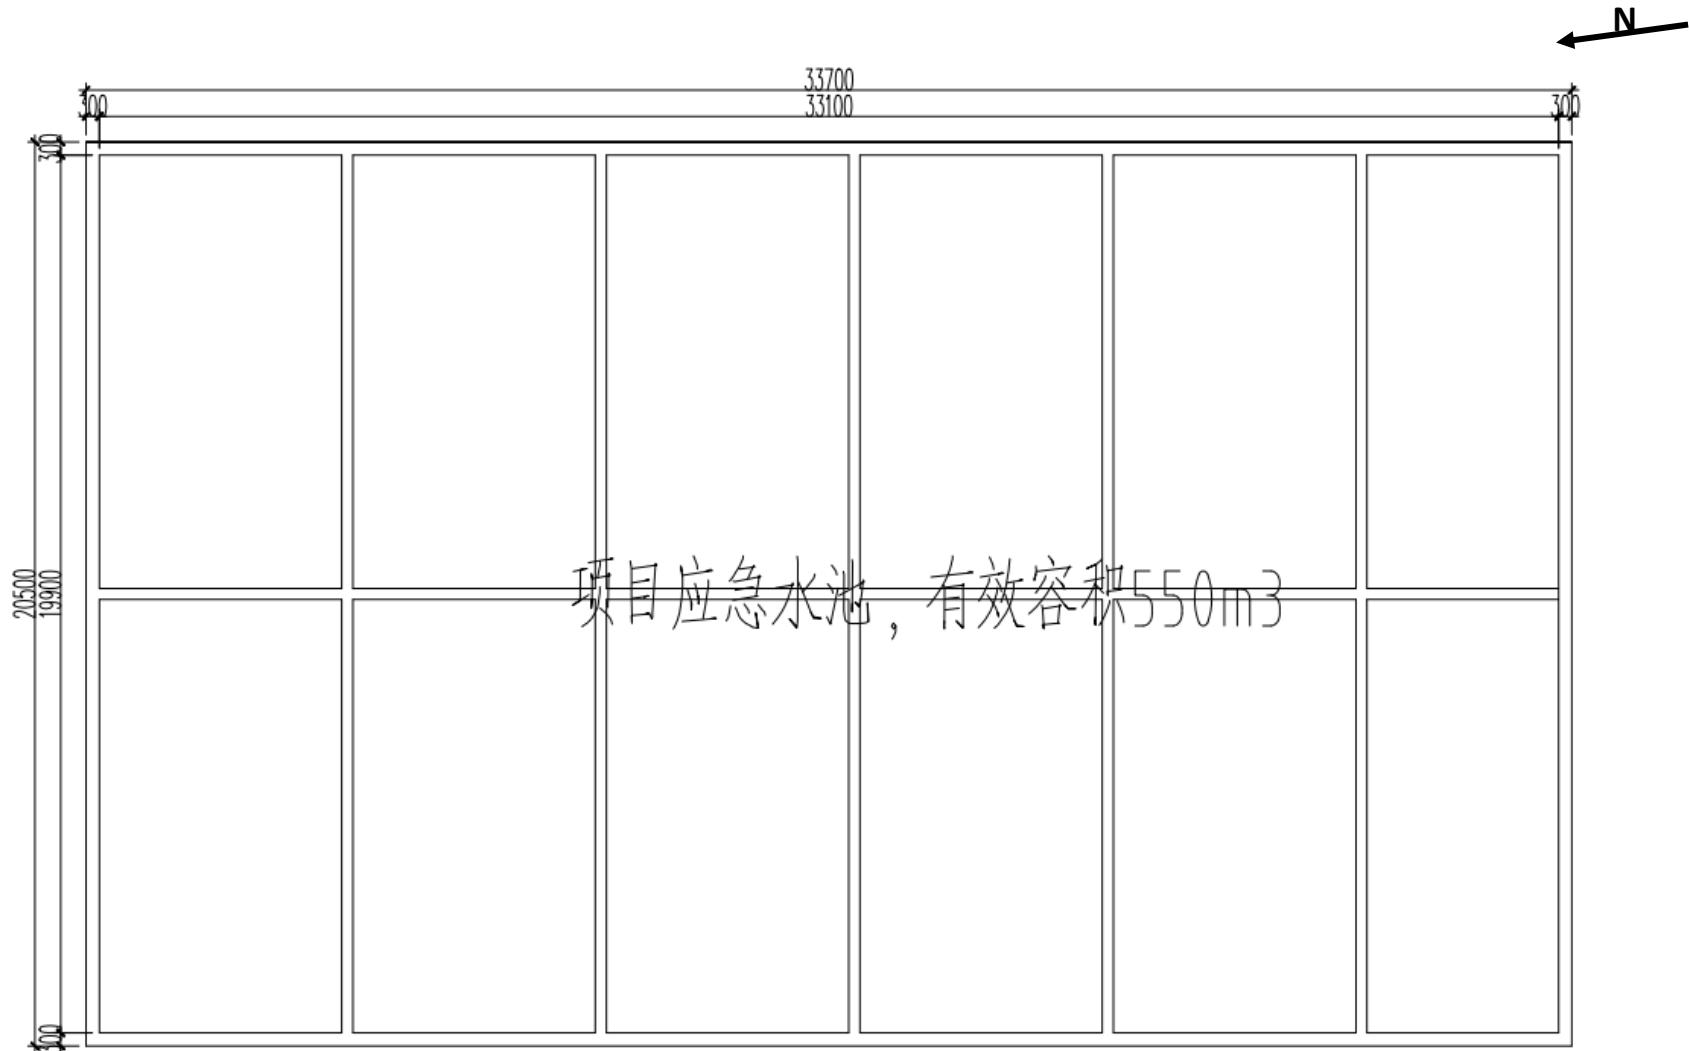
处理构筑物1一层平面布置图 (-0.8~0.2m)
